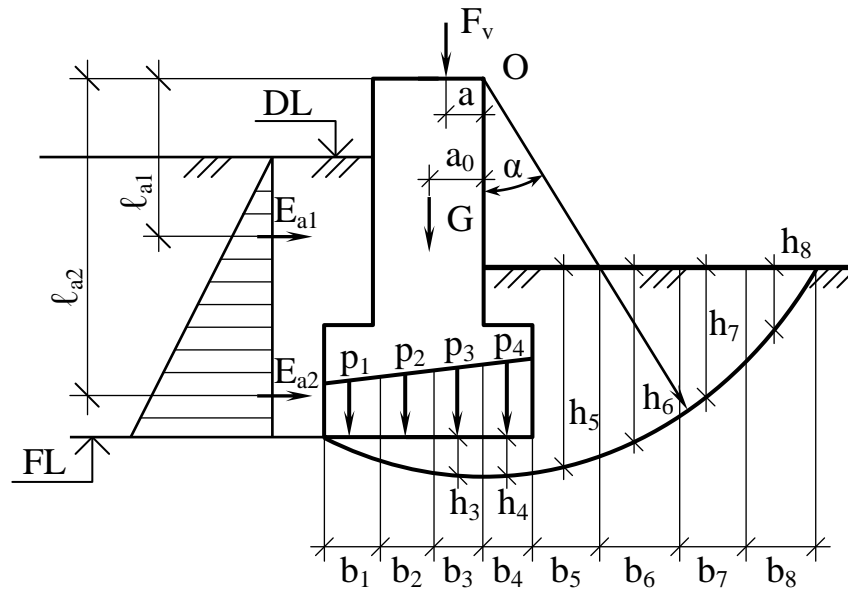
До розрахунку стійкості фундаменту з використанням схеми круглоциліндричної поверхні ковзання
